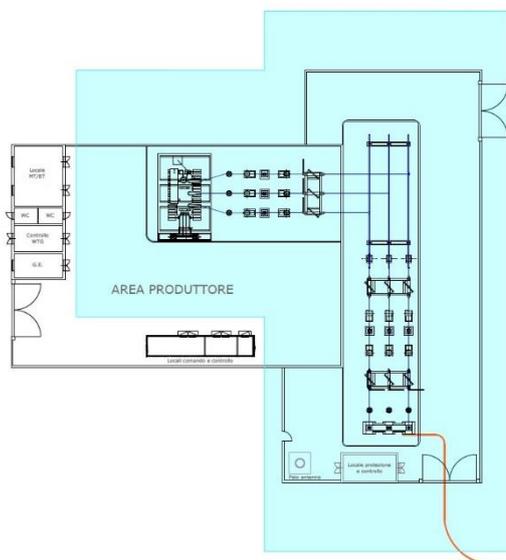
DPA pari a 14 m dalla sezione in AT della SSE
